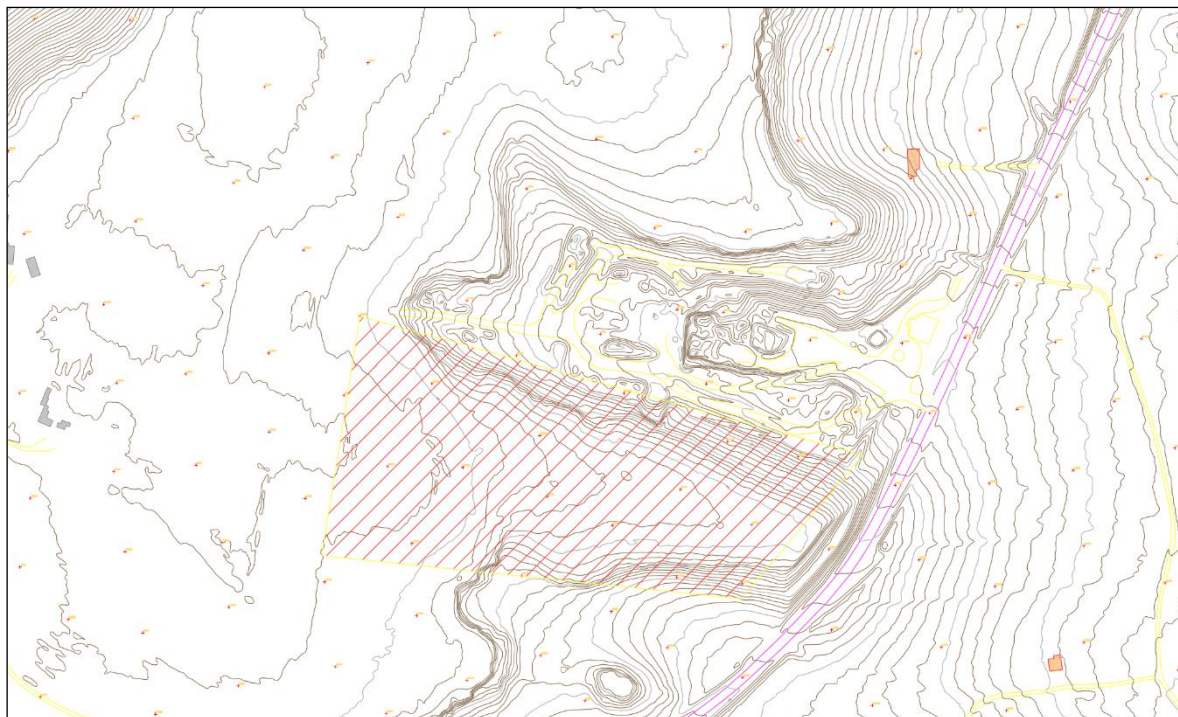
/B - Pianta estratta dal rilievo 2025 con tratteggio area su cui insisterà l'impianto
